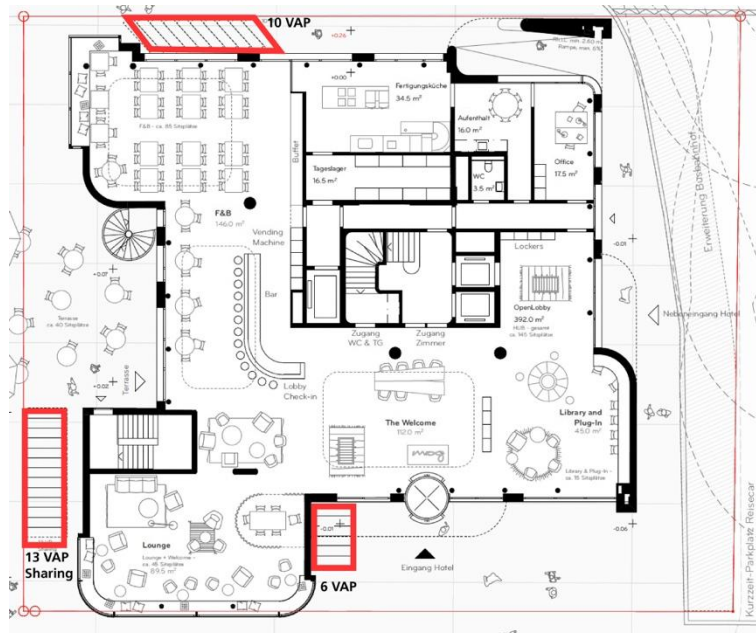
Ausschnitt Grundriss EG mit oberirdischen Abstellplätzen
